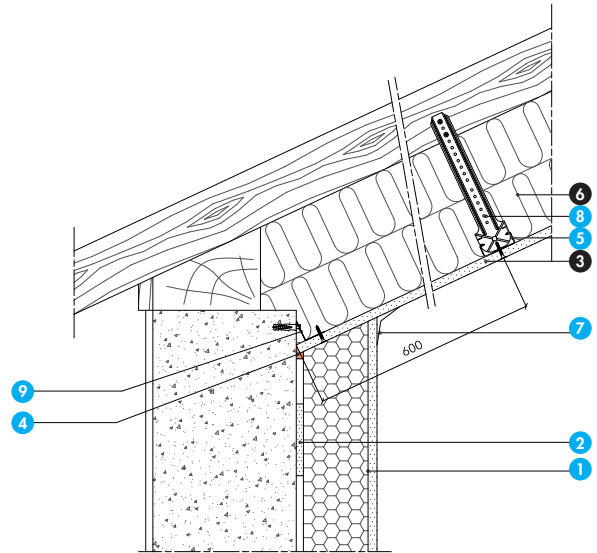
Étanchéité à l'air de la jonction plafonds/support/doublage
